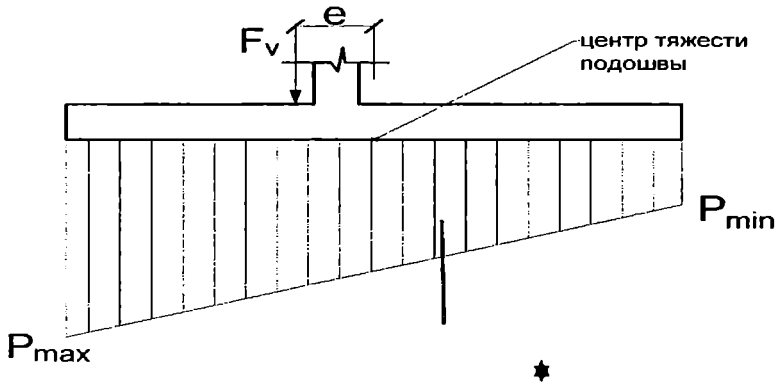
Схема для определения напряжений под подошвой опорной стенки
